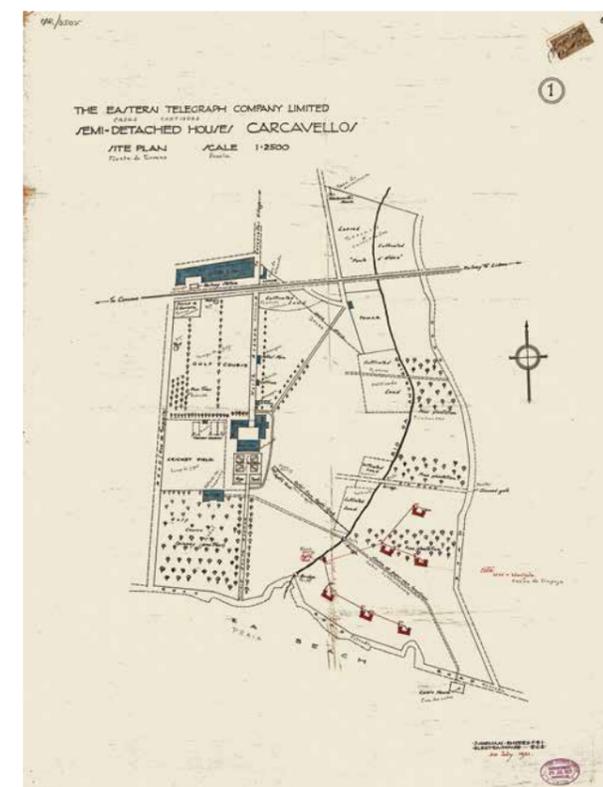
| Planta da Quinta Nova 1921. AHMC
